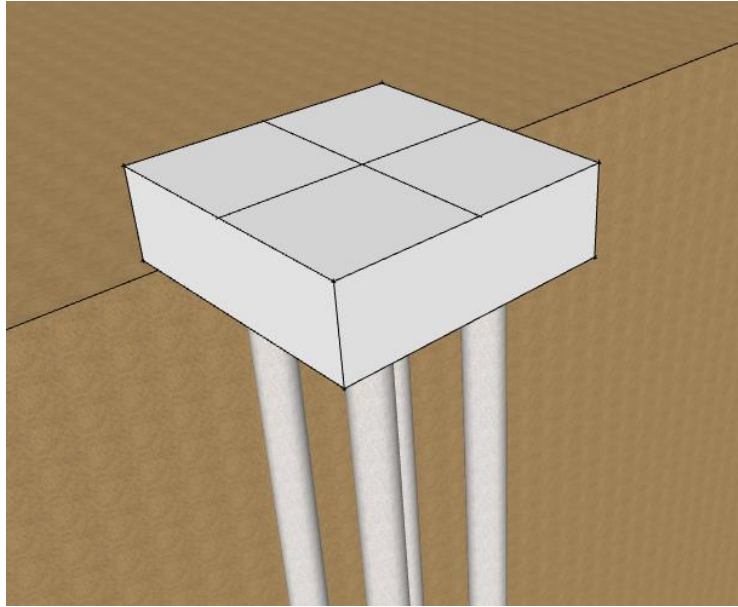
Grupos de pilotes colocados debajo de la zapata.
